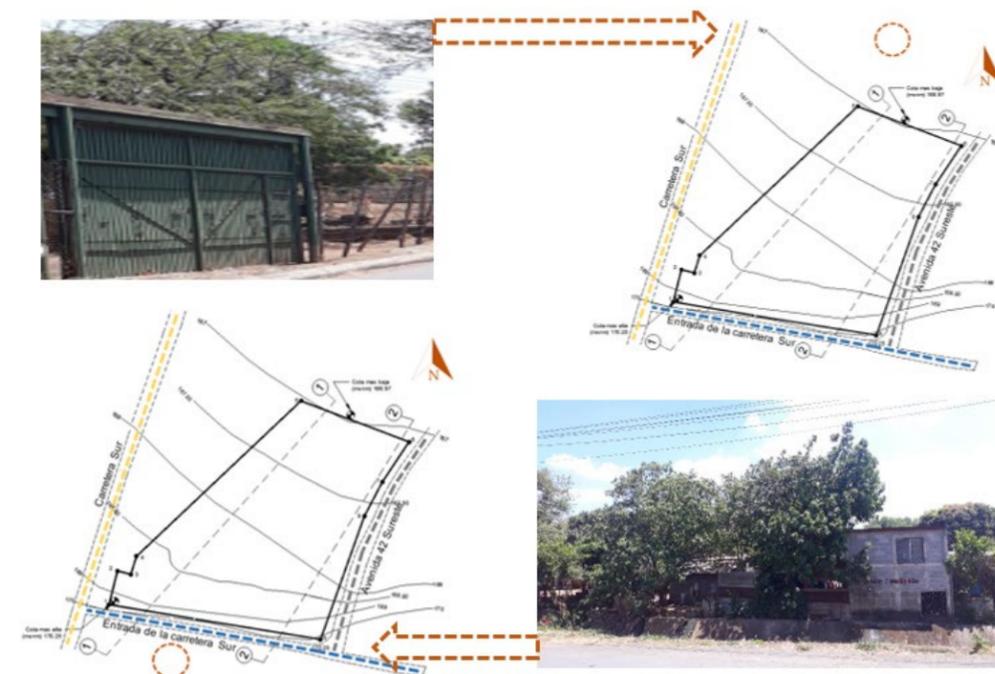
Perfiles Norte y Sur, linderos del terreno. Fuente: elaborado por los autores.
